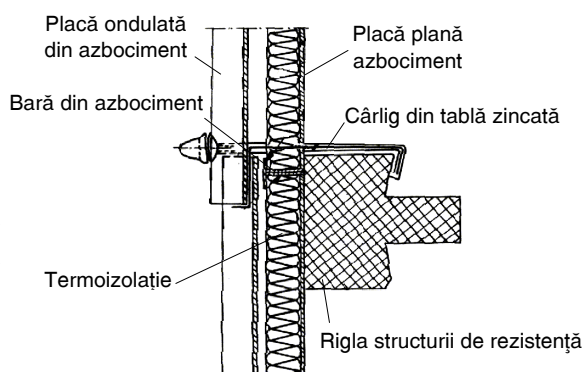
Panouri sandwich din plăci de azbociment plan și ondulat
